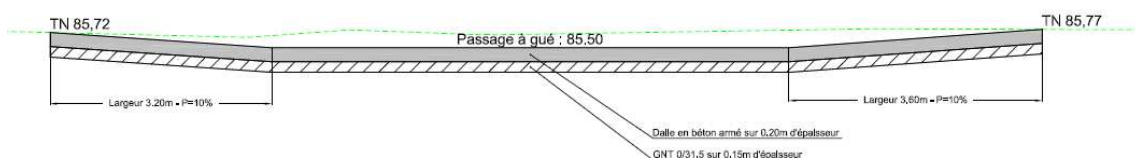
Coupe sur le passage bétonné sur le CR15
